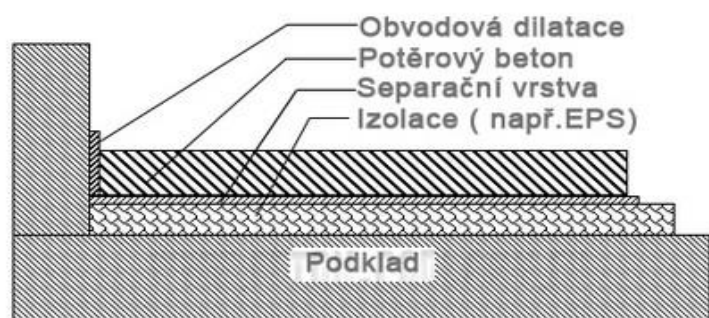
Řez konstrukcí - podlaha na separační vrstvě [6]
